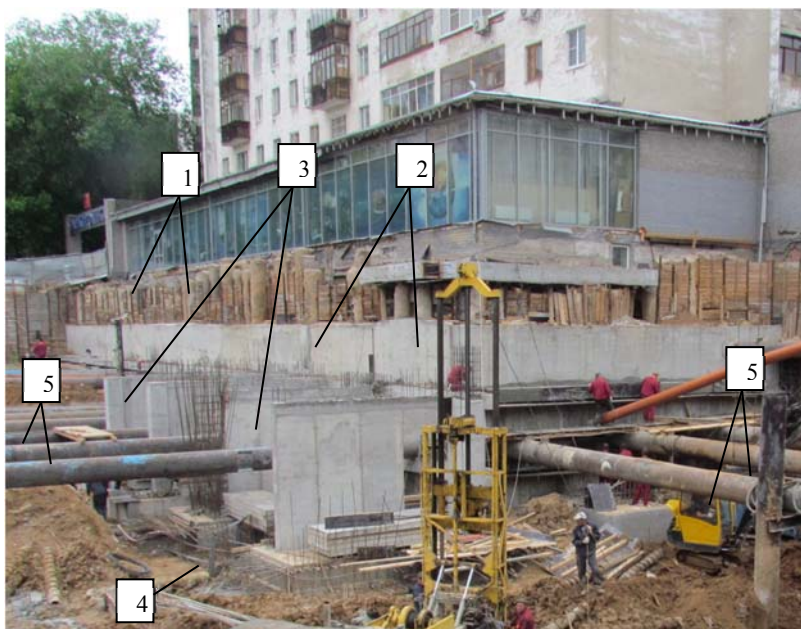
Схема закрепления подпорных стен котлована расстрелами из стальных труб 1000 мм: 1 – существующие буронабивные сваи ограждения котлована; 2 – ограждение котлована из монолитного железобетона; 3 – монолитные железобетонные контрфорсы усиления существующей подпорной стены; 4 – монолитный железобетонный ростверк; 5 – существующие трубы – расстрелы усиления подпорных стен
